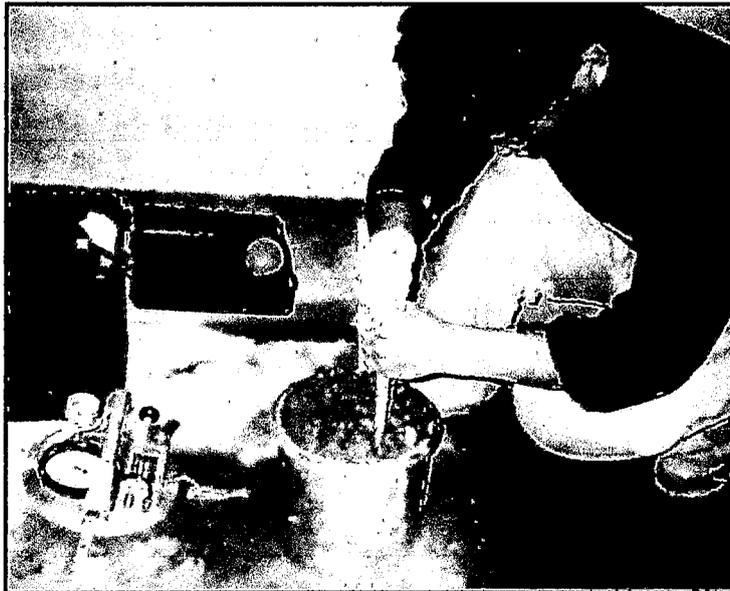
Determinación del contenido de aire para el concreto fresco. Se puede ver el equipo tipo Washington.
